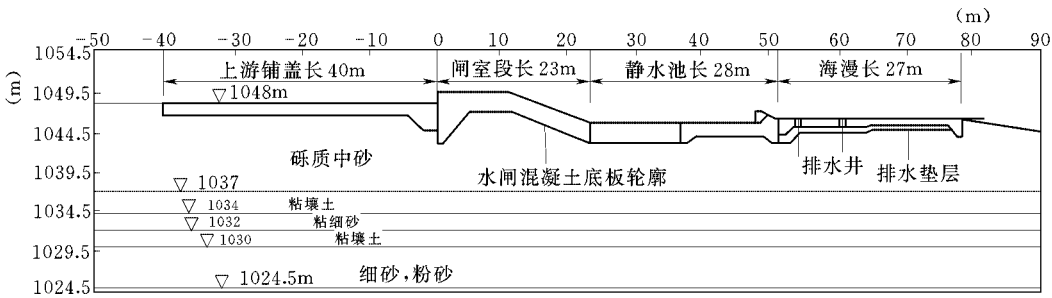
黄河三盛公水利枢纽拦河闸概化地质剖面图
